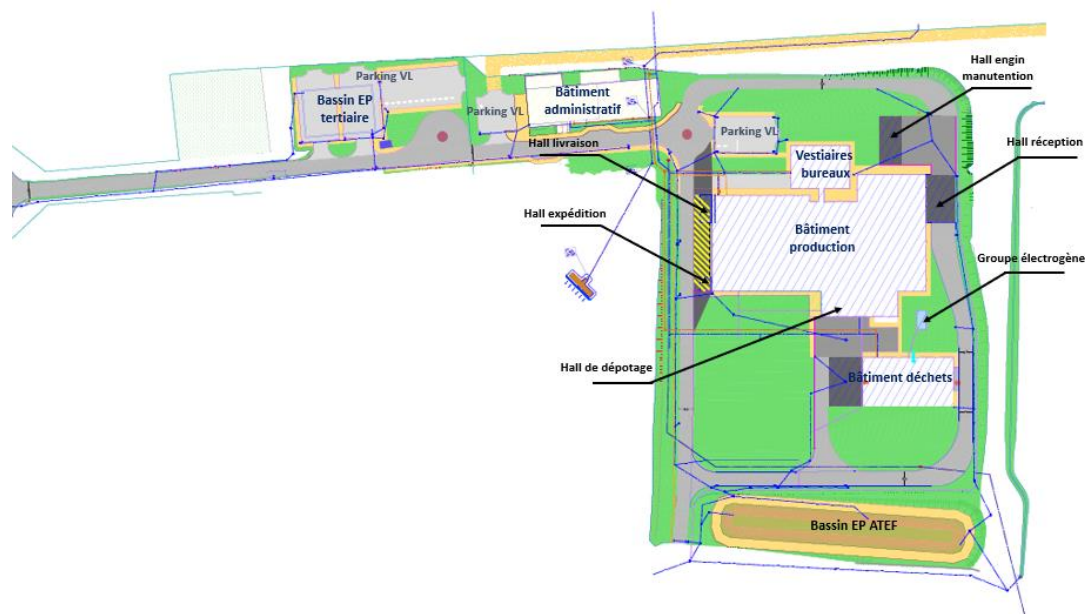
Bâtiments du projet d'installation ATEF (plan d'implantation)
